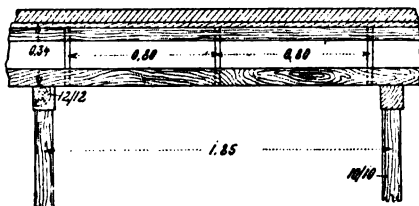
Verschalung einer Rippendecke mit Holzkasten.
